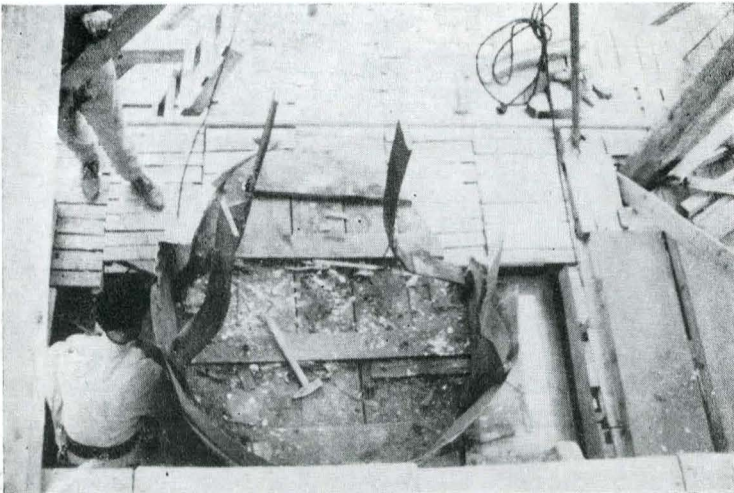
Postamentul de lemn al carului de pe turnul de est
